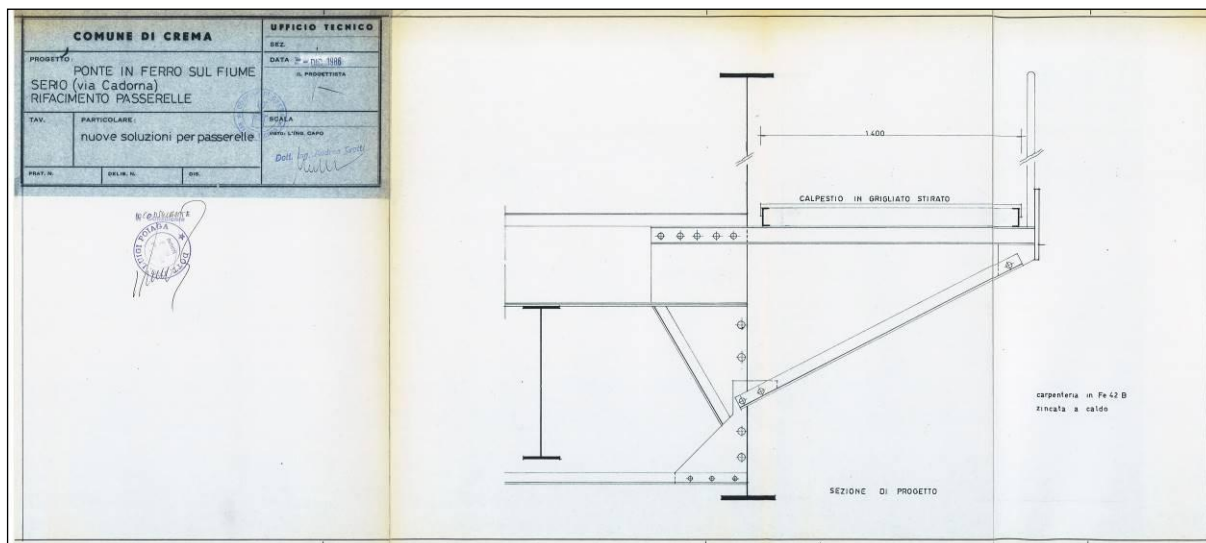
Sezione ripo del ponte – stato di progetto (dettaglio passerella)
